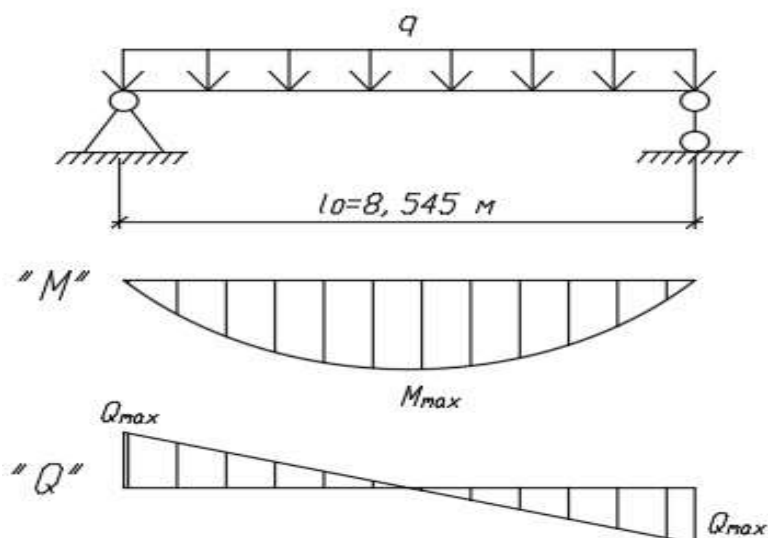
Расчетная схема и эпюры моментов и поперечной силы
